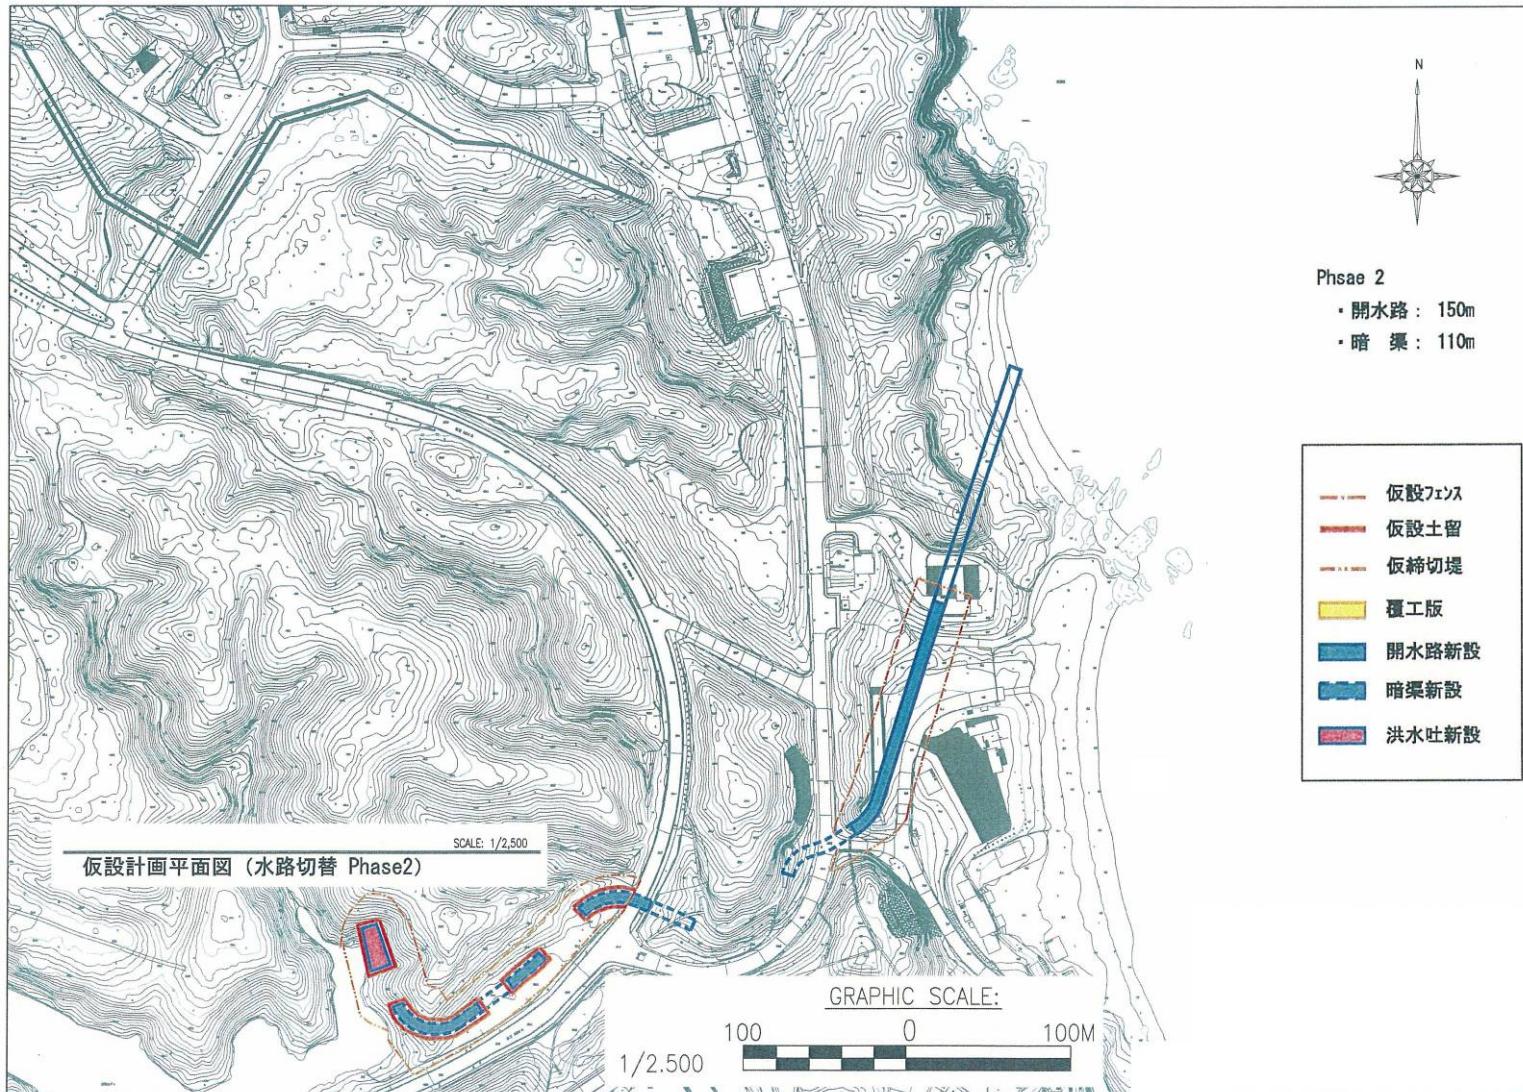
(2) 美謝川の切替え仮設計画平面図 (Phase2)
